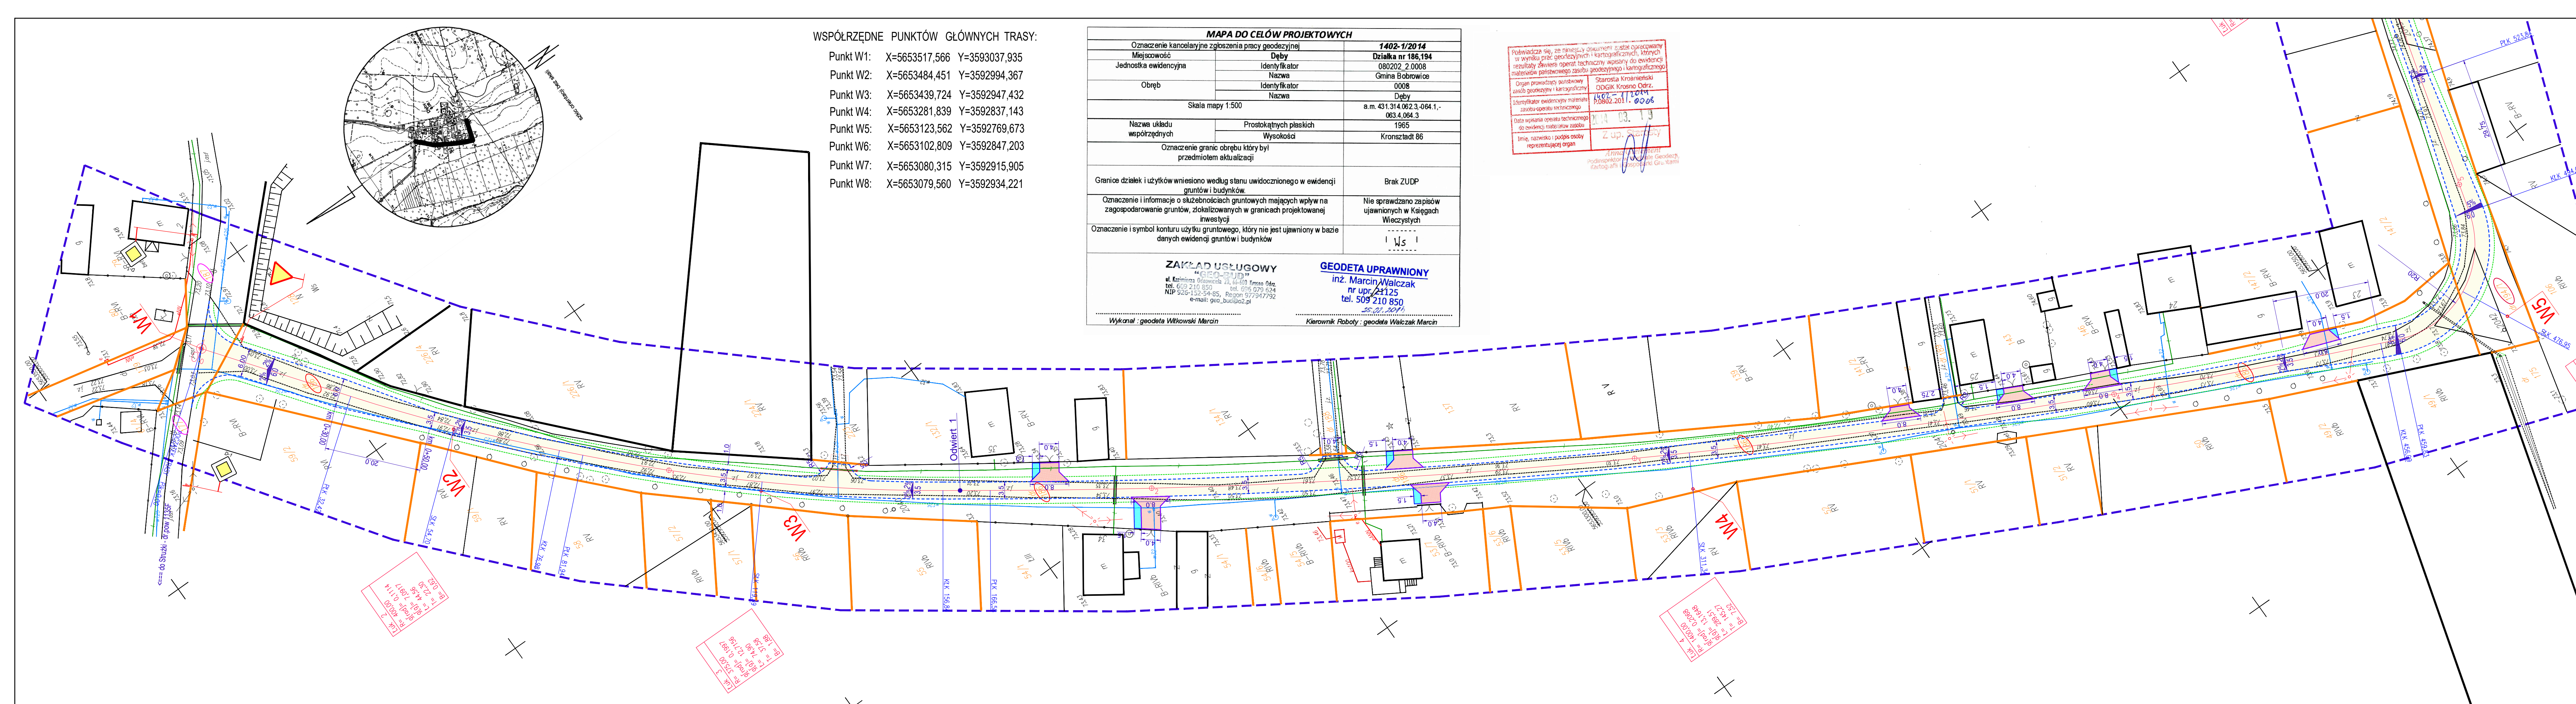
Plan Orientacyjny	str. 14
